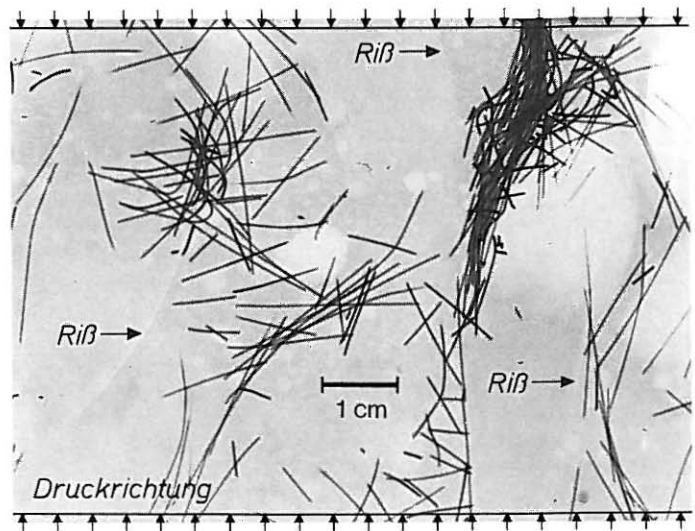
Röntgenaufnahme eines Stahlfaserbetons mit Hafrissen
